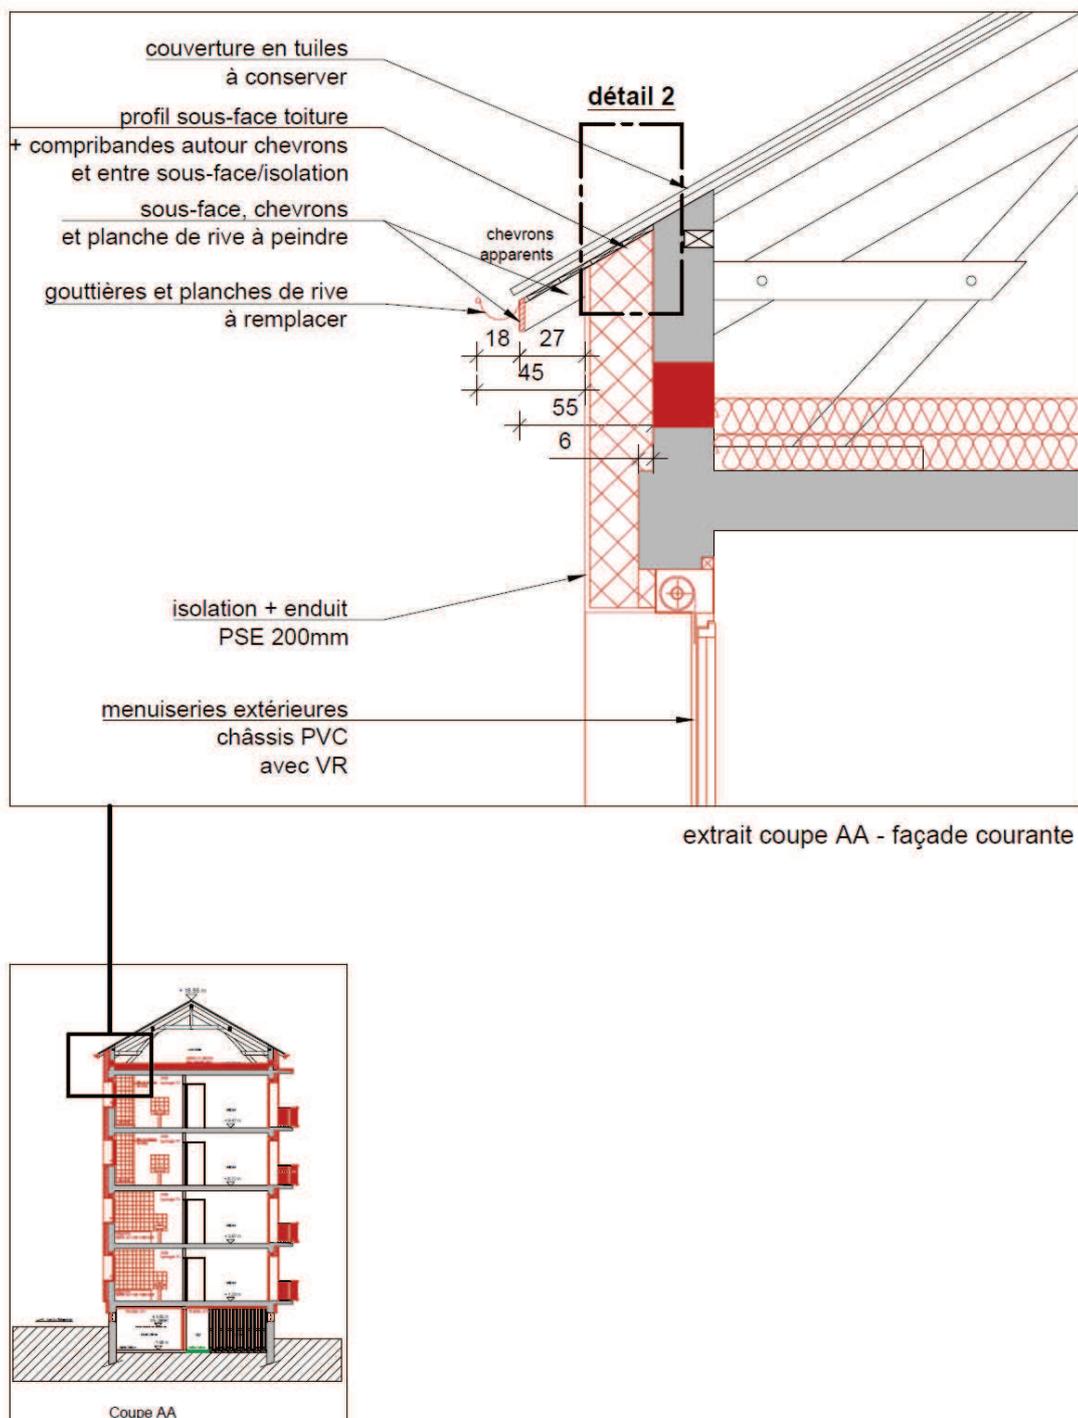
Extraits de coupe – Détails ITE des combles et sous-face toiture (façade courante)
